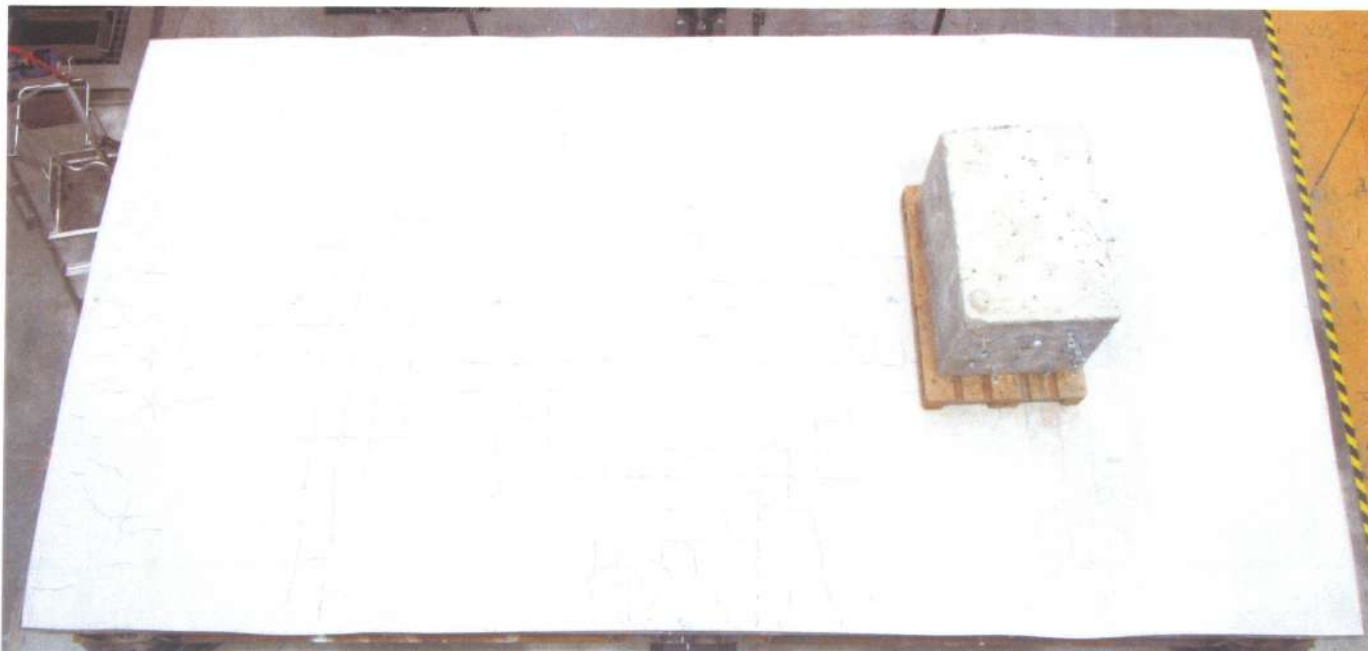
Détail de la fissuration avant essai (fissures de retrait)
